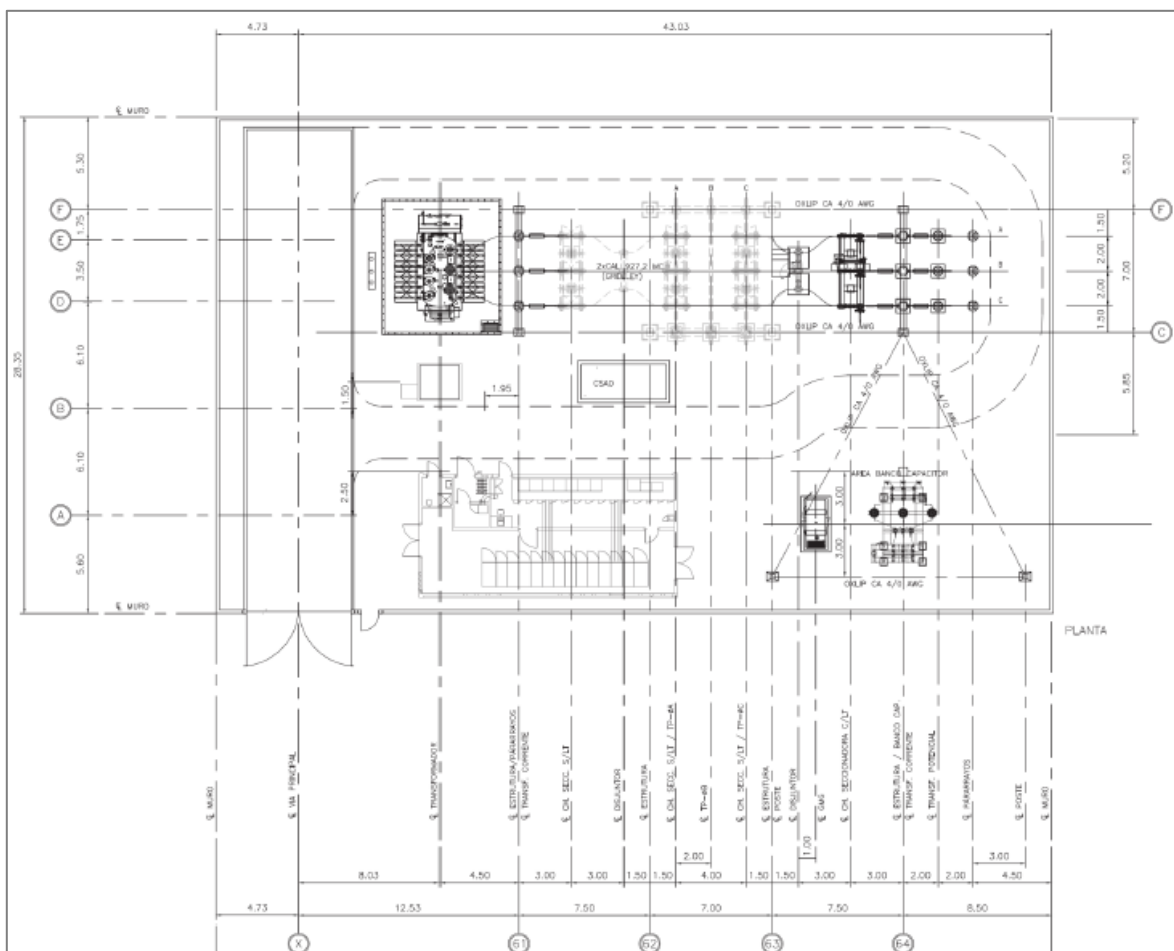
Vista en planta tipo de la subestación eléctrica 34.5/115 kV
